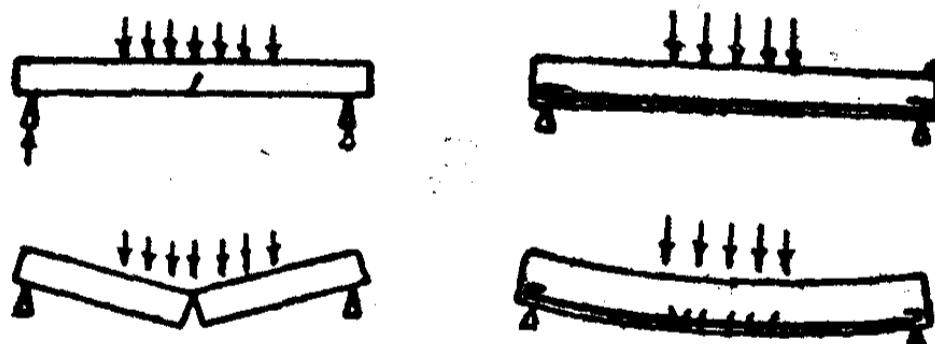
純混凝土与鋼筋混凝土梁工作示意
